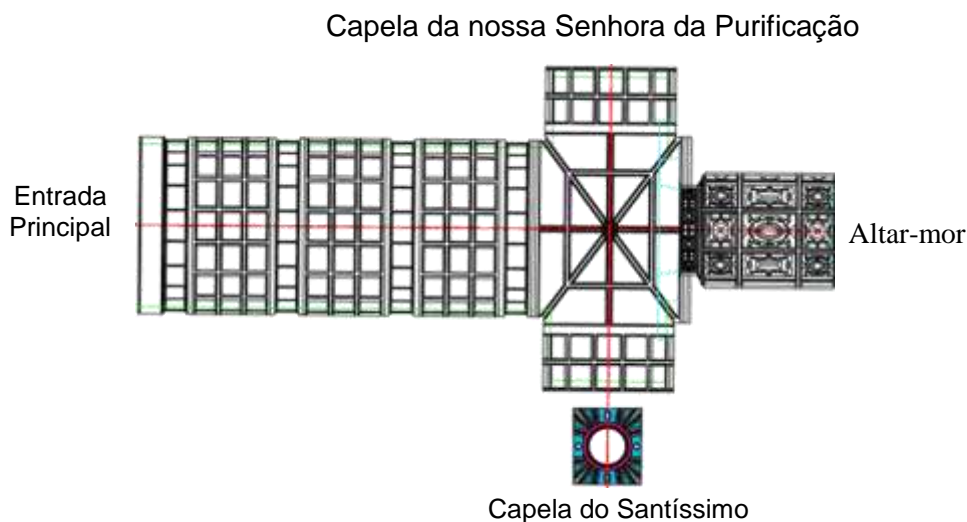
Planta em cruz latina (nave central, crucero e transeptos)
